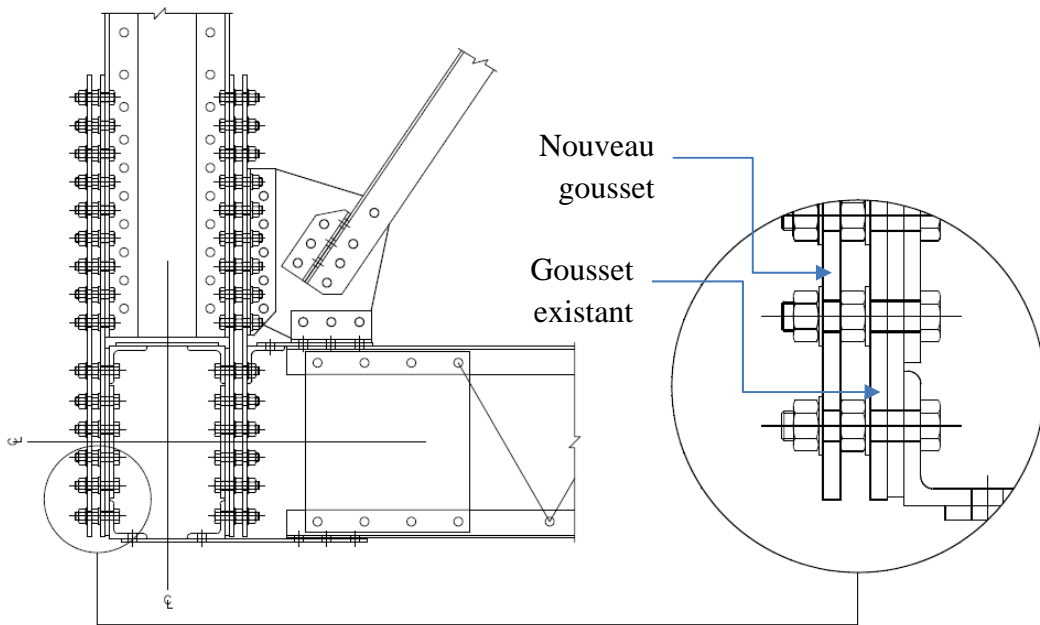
Renforcement d'un gousset par l'ajout de nouveaux goussets (*Cedar Street Truss Bridge*)
